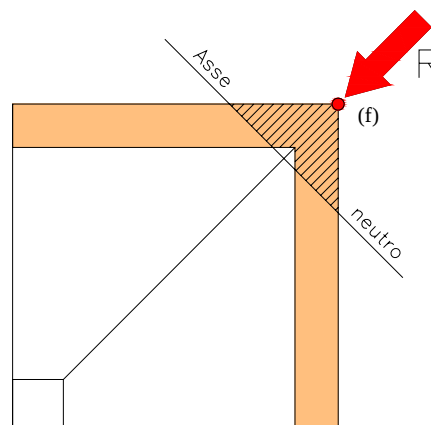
Particolare planimetrico della sezione alle reni di volta a crociera con il filo (f) della nervatura situato in zona compressa.
